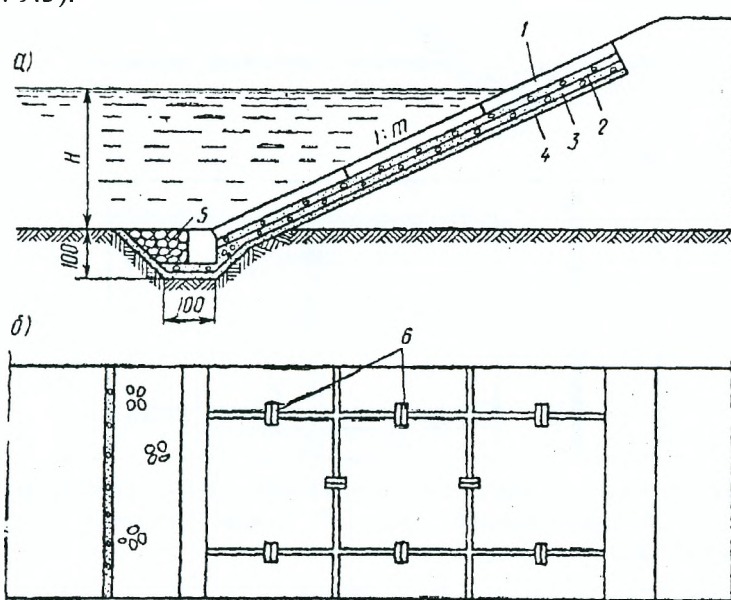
Укрепление откоса насыпи сборными железобетонными разрезными плитами: а – разрез; б – план; 1 – сборные плиты; 2 – крупный щебень или гравий толщиной слоя 15 см; 3 – мелкий щебень или гравий толщиной слоя 10 см; 4 – крупный песок толщиной слоя 10 см; 5 – каменная призма с бетонным упором; 6 – шарнирные соединения плит
